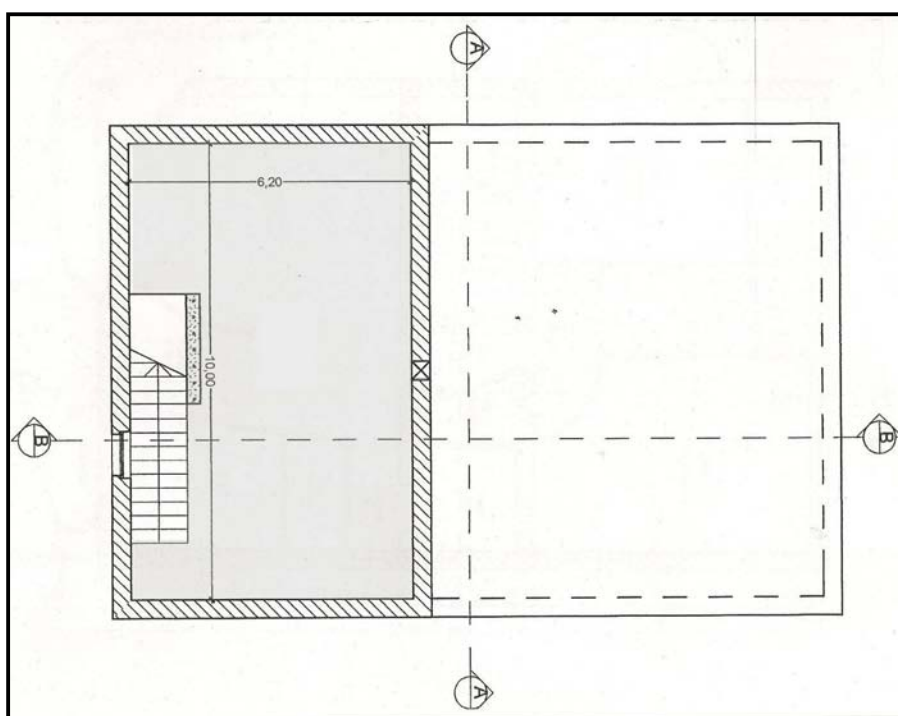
Cantina al piano interrato: planimetria dei locali.
